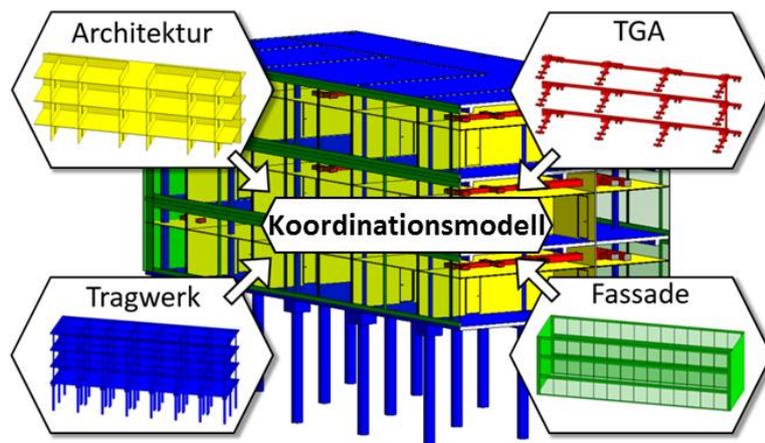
BIM – Koordinations- und Fachmodelle.
